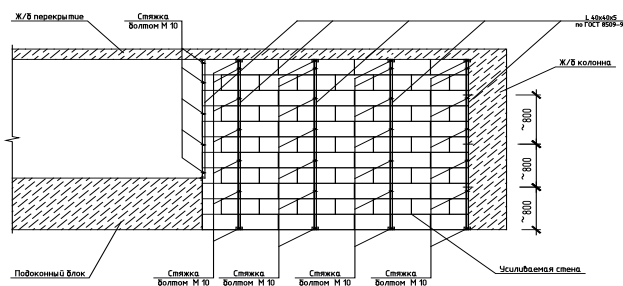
Схема расположения элементов усиления стен из блоков газобетона
